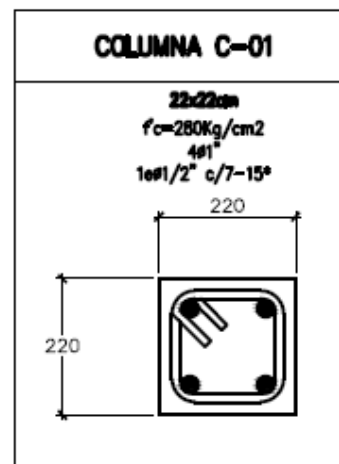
B. Armado de las columnas indicando sus dimensiones.
